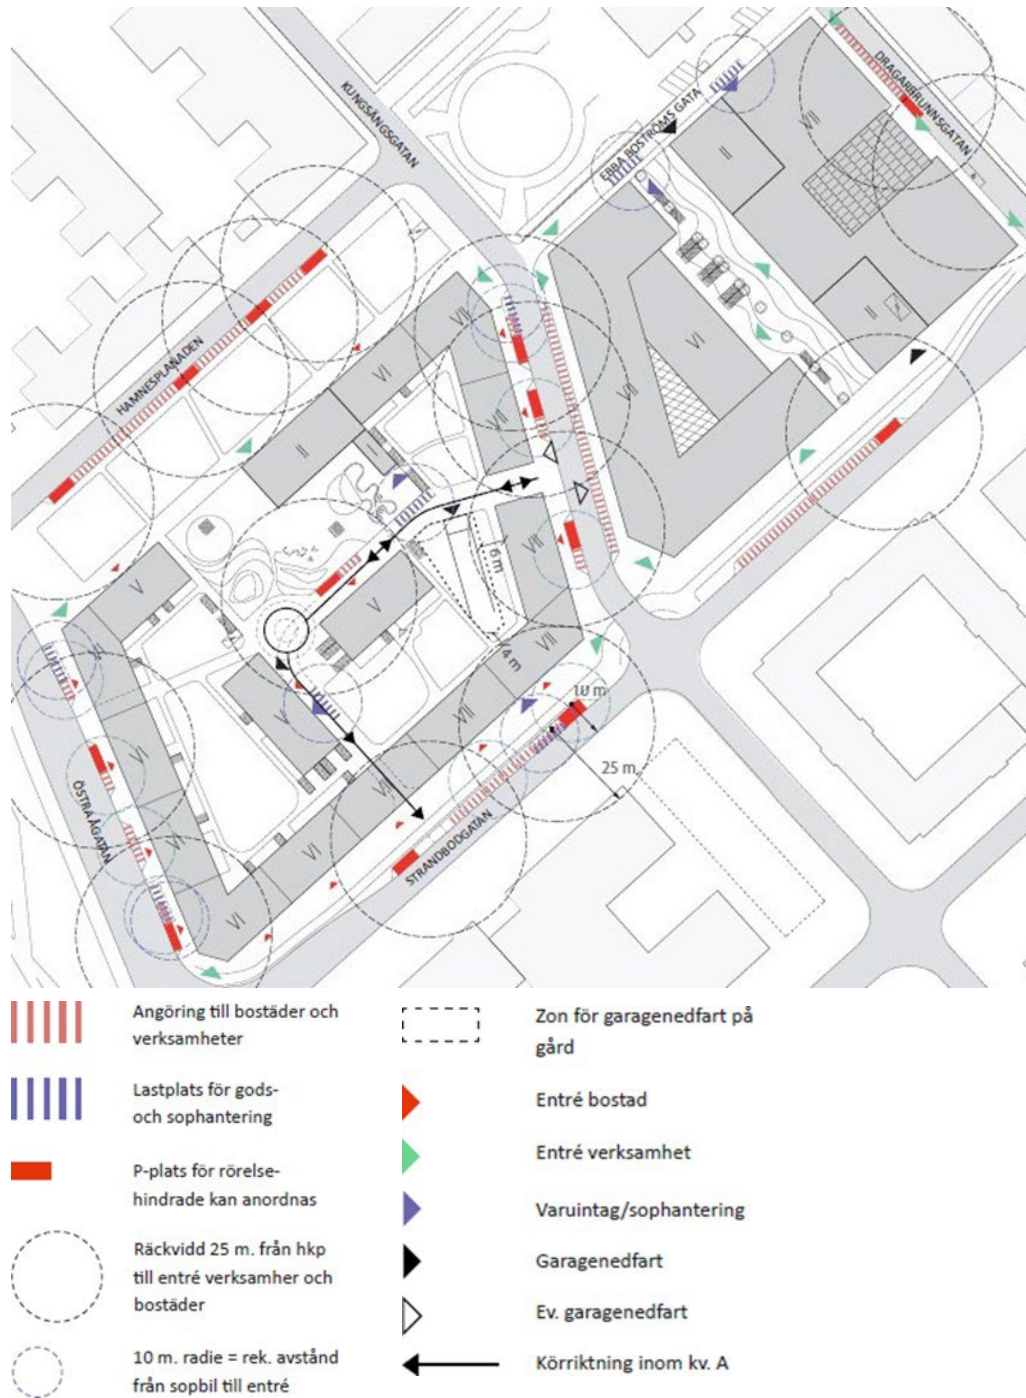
Illustrationsplan som visar möjliga platser för angöring, Alma arkitekter.
